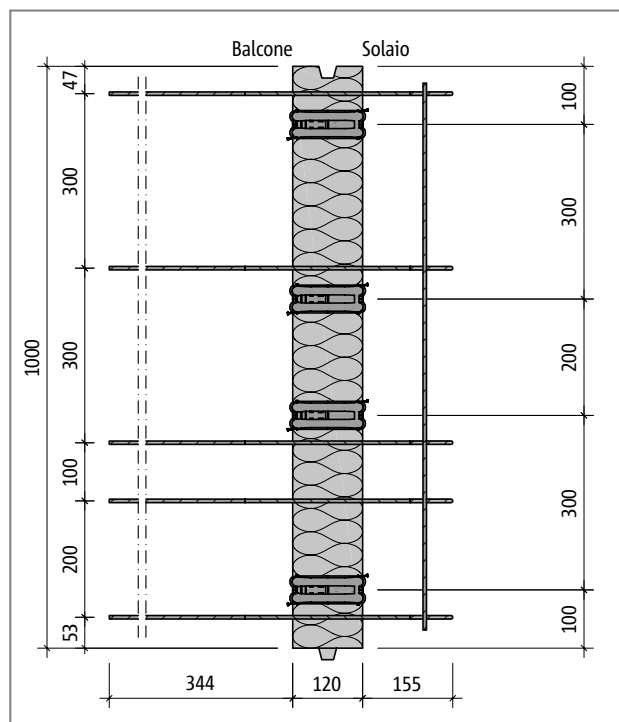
Schöck Isokorb® tipo QXT10: pianta del prodotto
